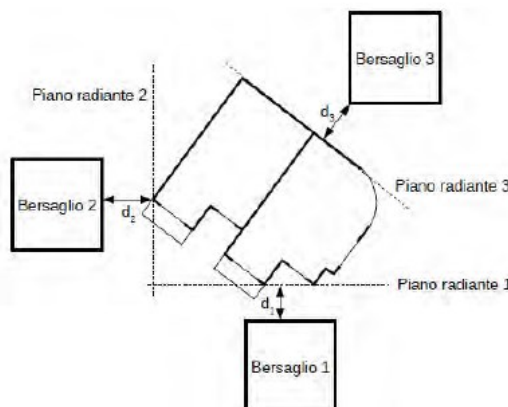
Determinazione del piano radiante, vista in pianta delle costruzioni
